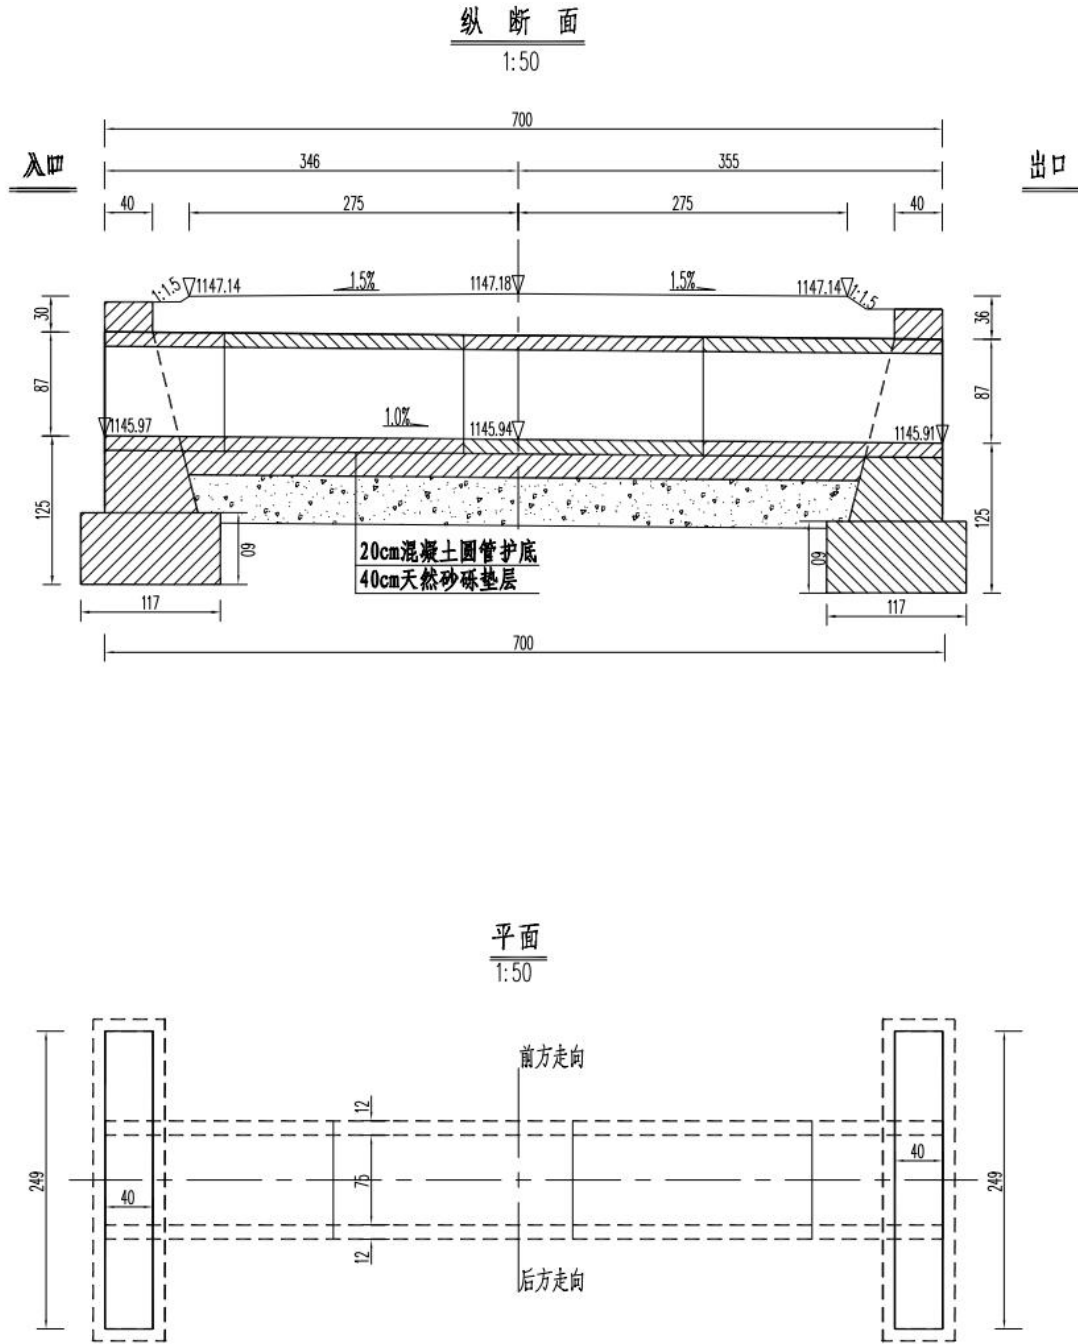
1-0.75m 钢混凝土圆管涵布置图
